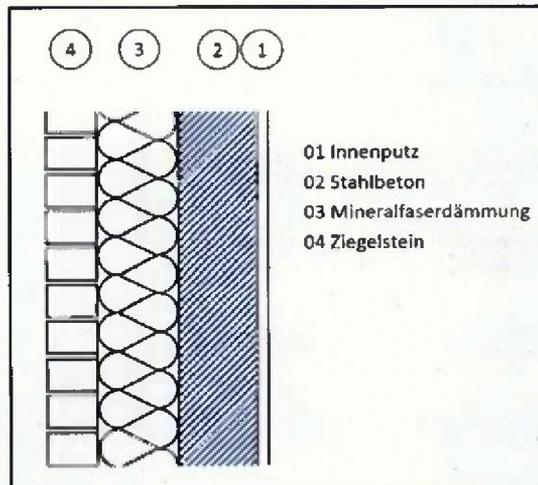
Außenwandaufbau des Typgebäudes „Basic“ in Stahlbeton-Bauweise
